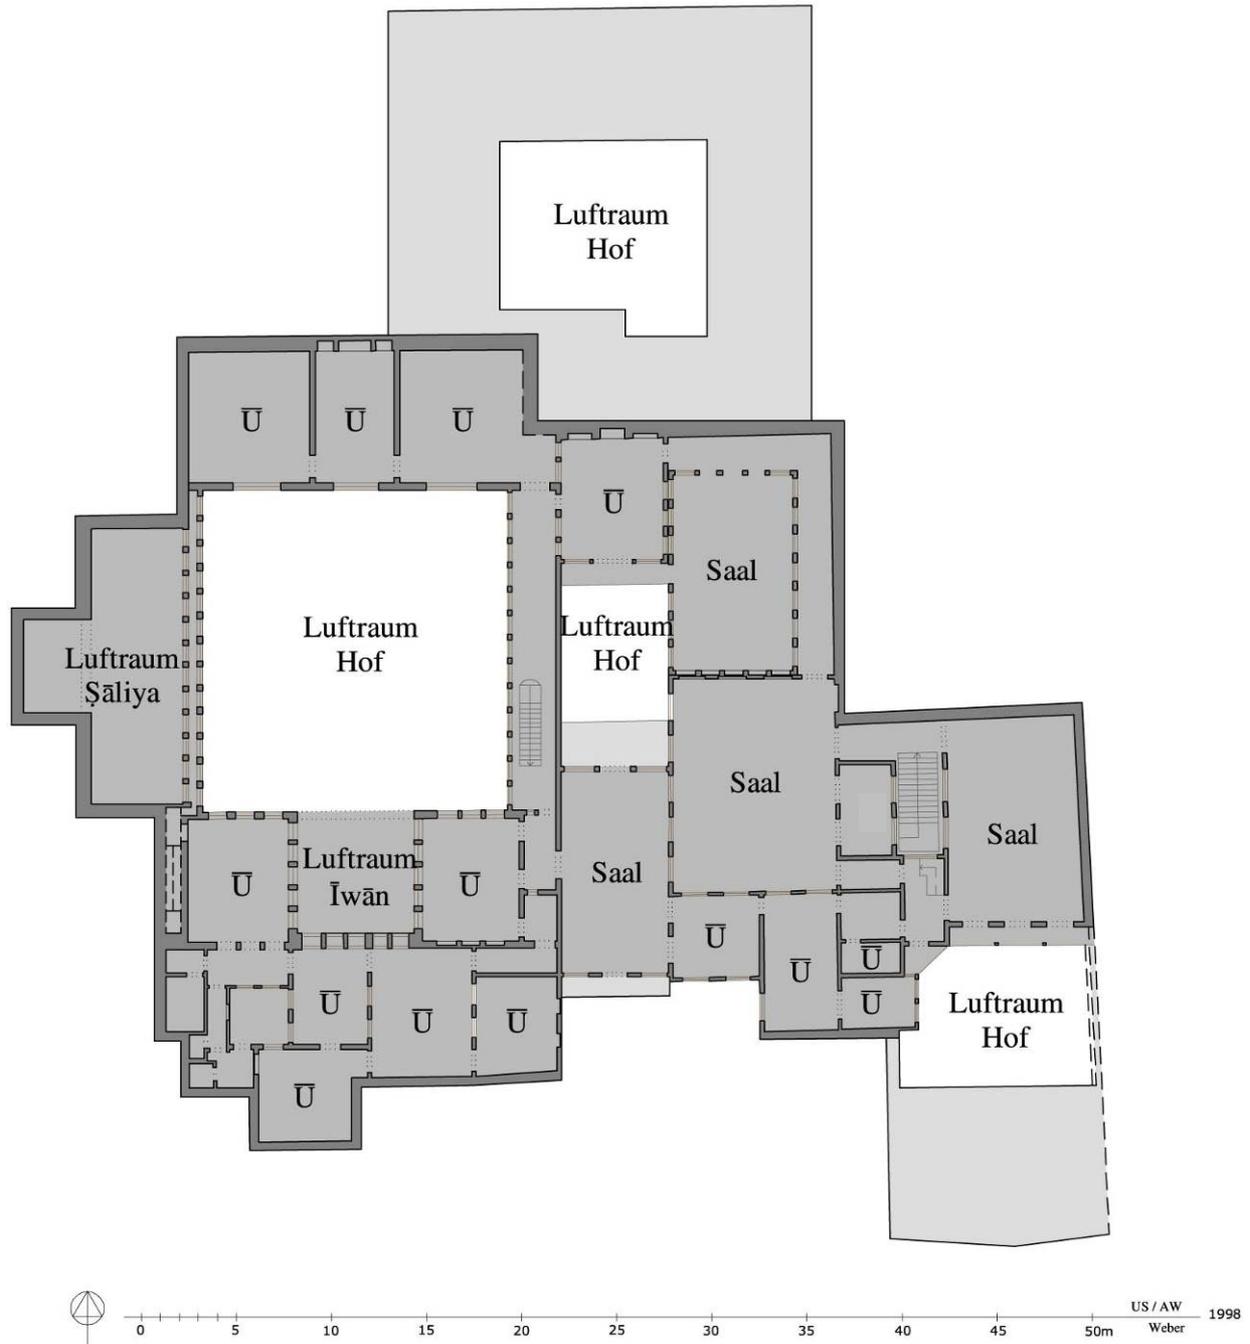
Bayt al-Yūsuf, Grundriss OG
